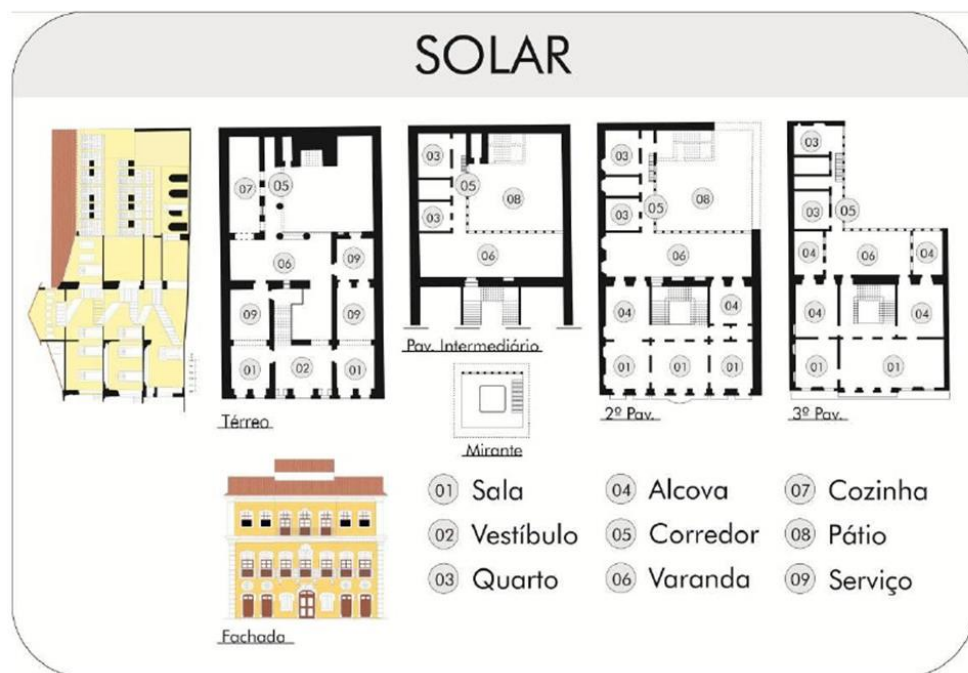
Desenhos esquemáticos de um Solar (fachadas, cortes e plantas baixas). Fonte: FIGUEIREDO, 2014: 49, adaptado de SILVA FILHO, 1998 (1986).
